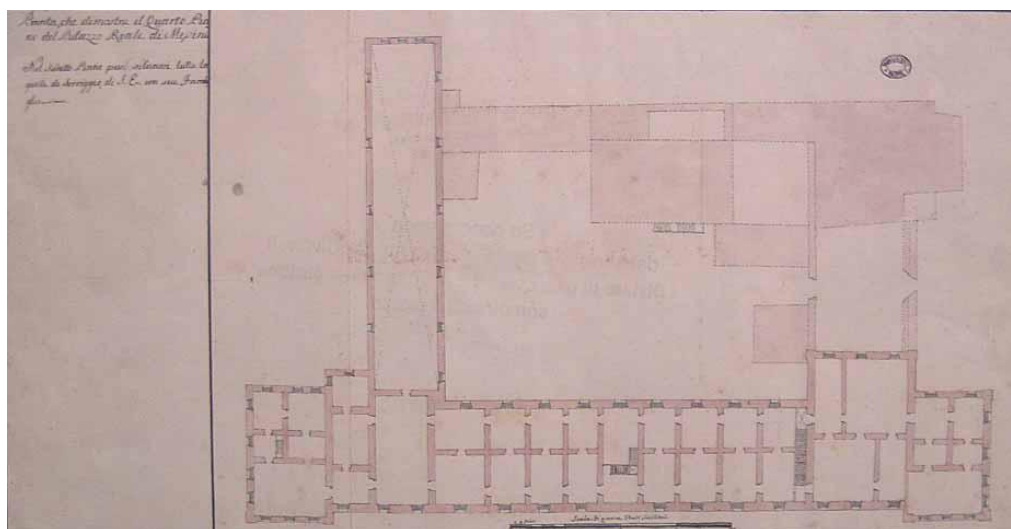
Pianta del terzo piano del palazzo Reale di Messina, 1751, Palermo, Archivio di Stato.
